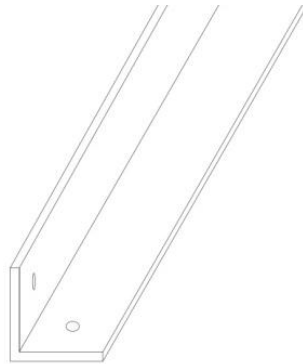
Detalle de perfiles metálicos Tipo L. Autor: Omar Acuña. 2014.
